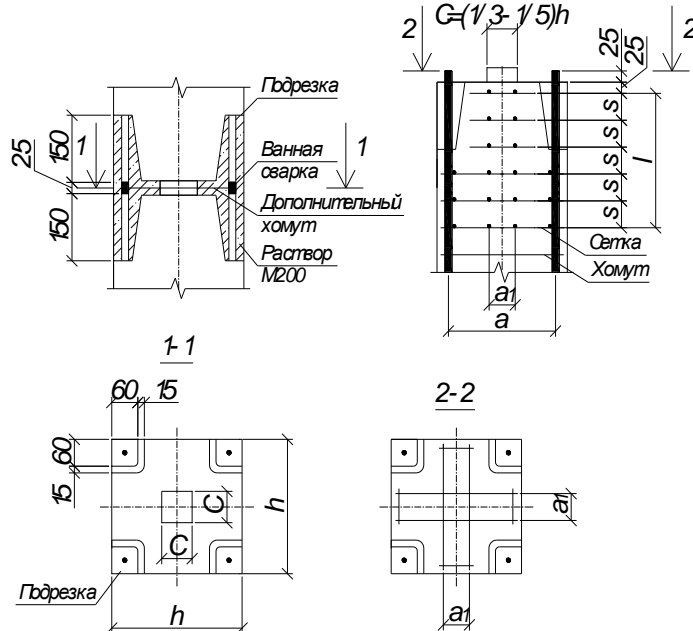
Стык колонн с ванной сваркой выпусков арматуры
